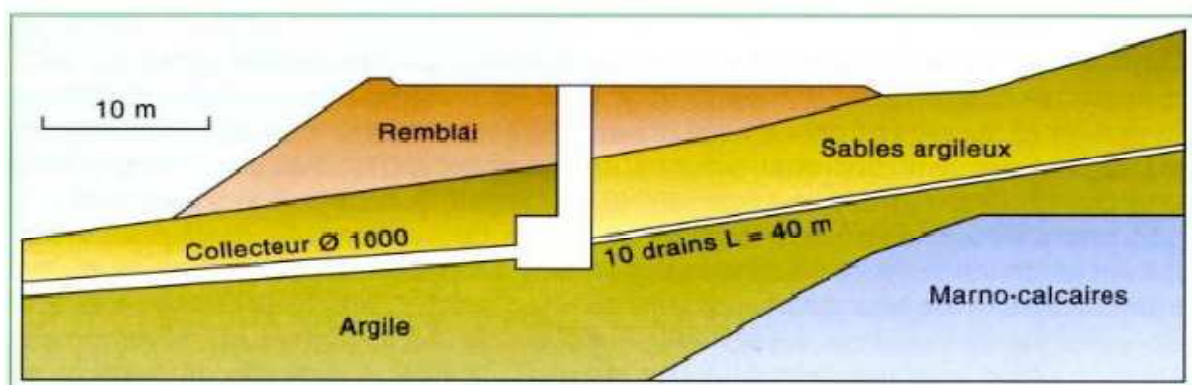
Drains subhorizontaux ; Drainage du glissement de Châtel Guyon (France)
